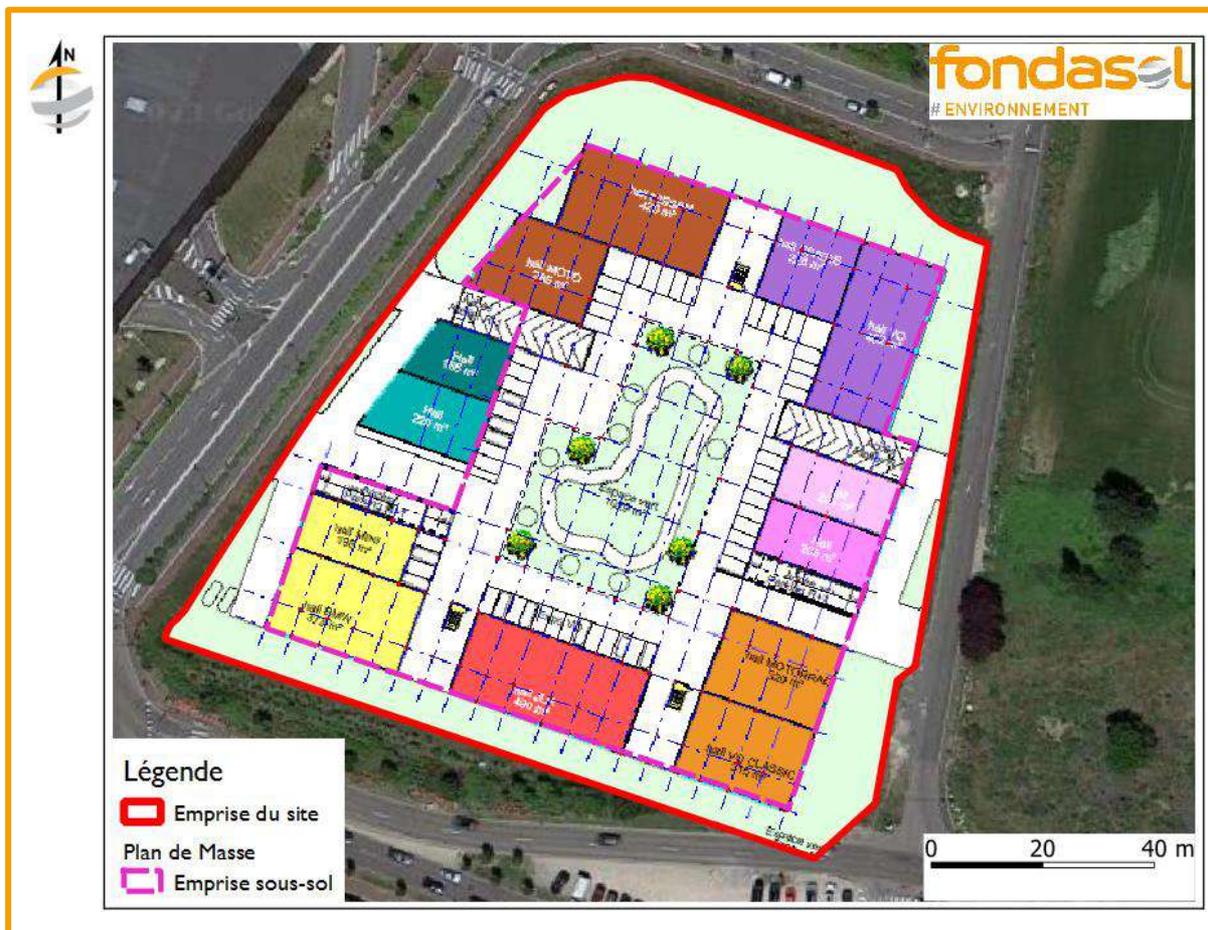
Plan de masse du projet en date du 10/10/22 (source : Plan APS 03 réalisé par Archipel 41)
